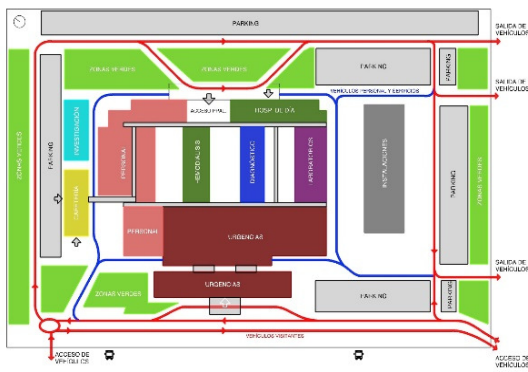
Propuesta de plano de situación (Fuente: los autores)
